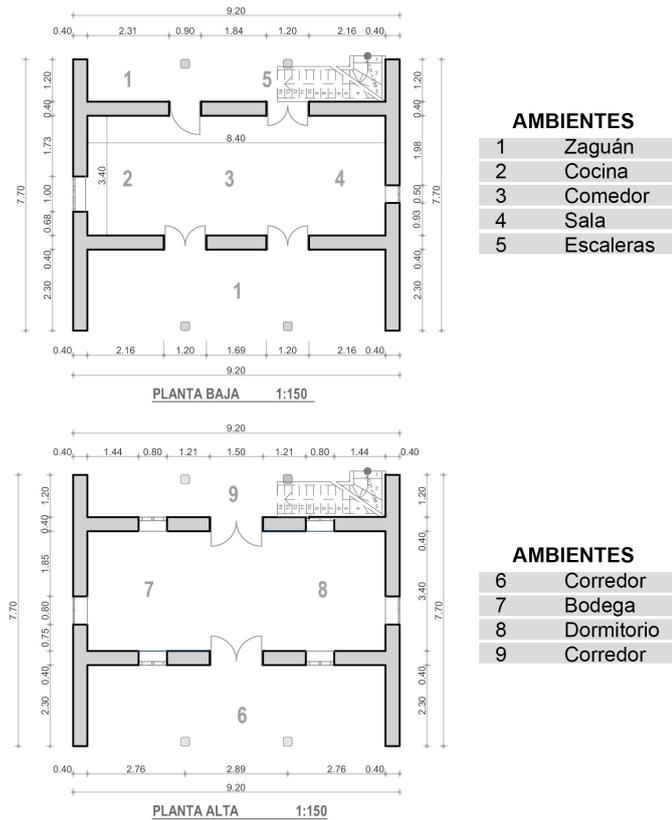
Plantas arquitectónicas de la edificación C 102
